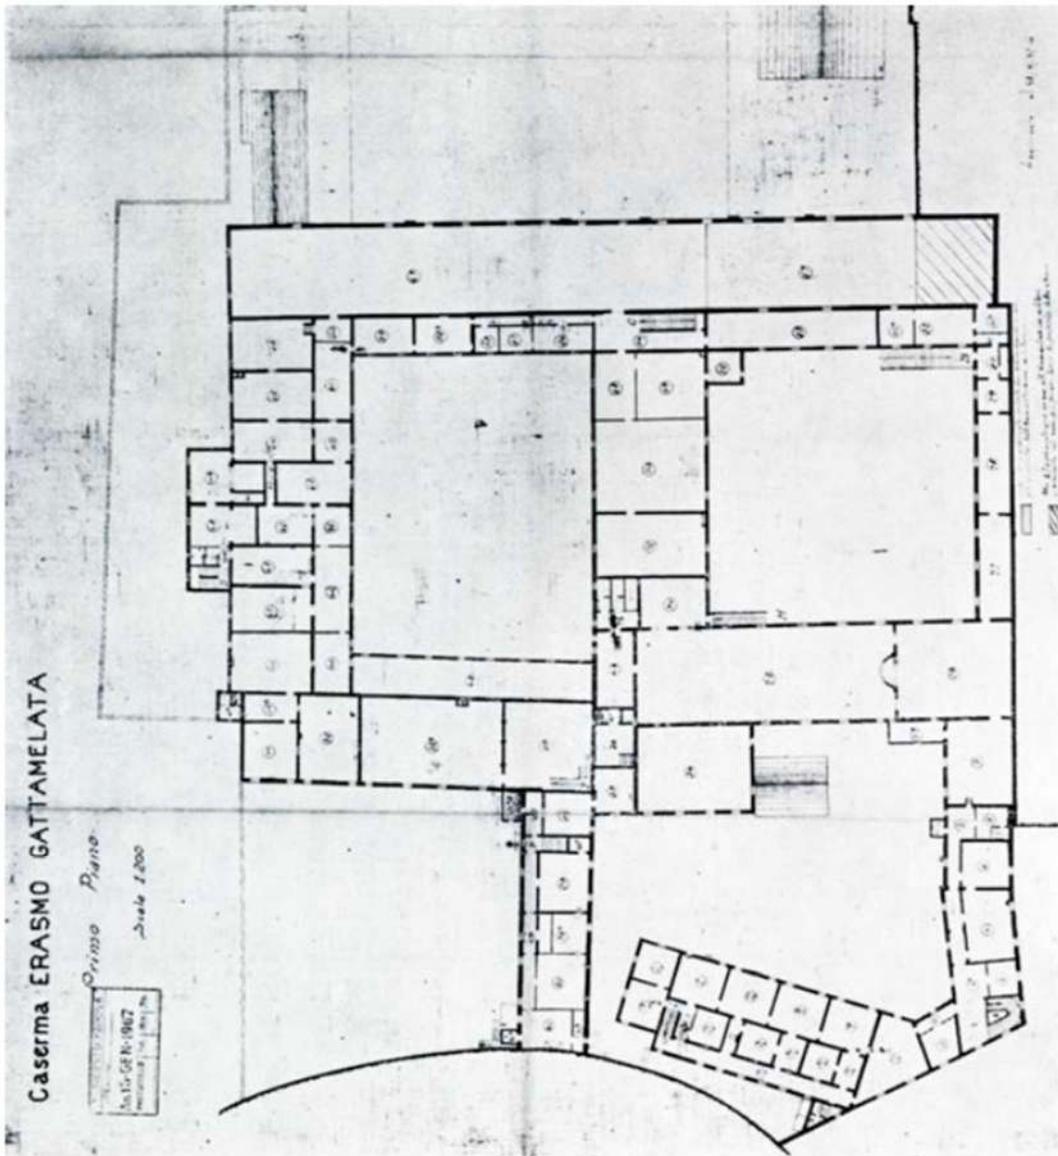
Planimetria Caserma Gattamelata Primo Piano, 1937
